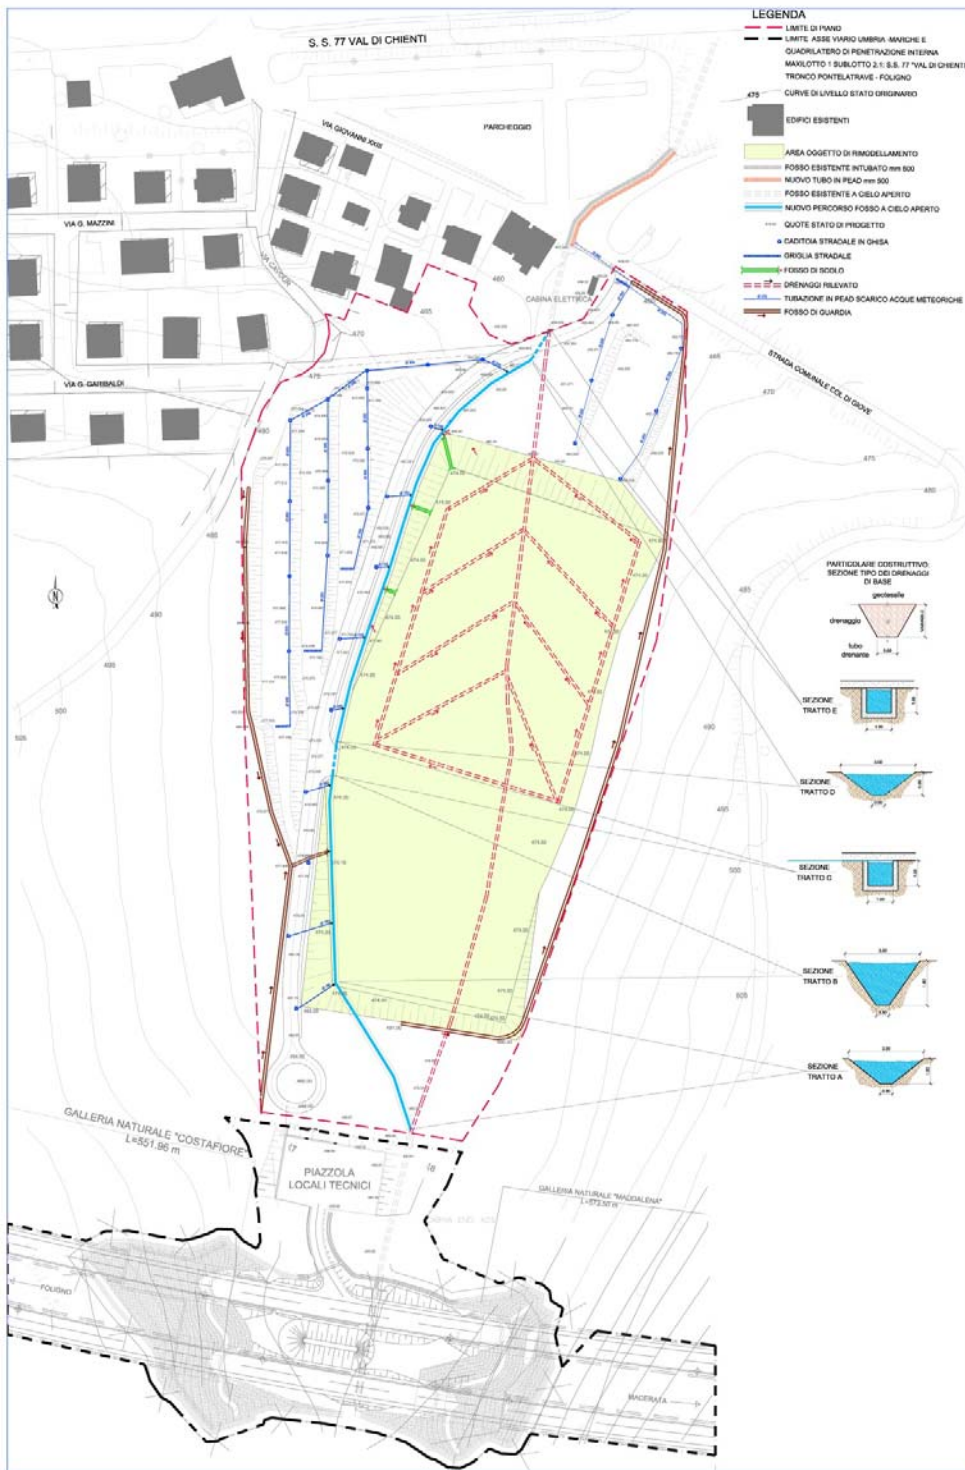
SCHEMA DRENAGGI DI PROGETTO
